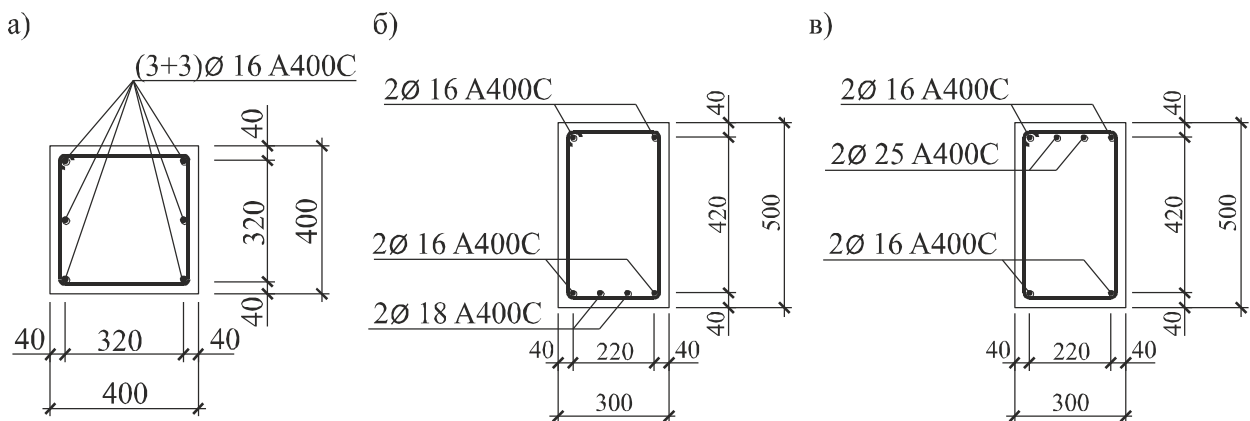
Армування елементів залізобетонного рамного каркасу:
